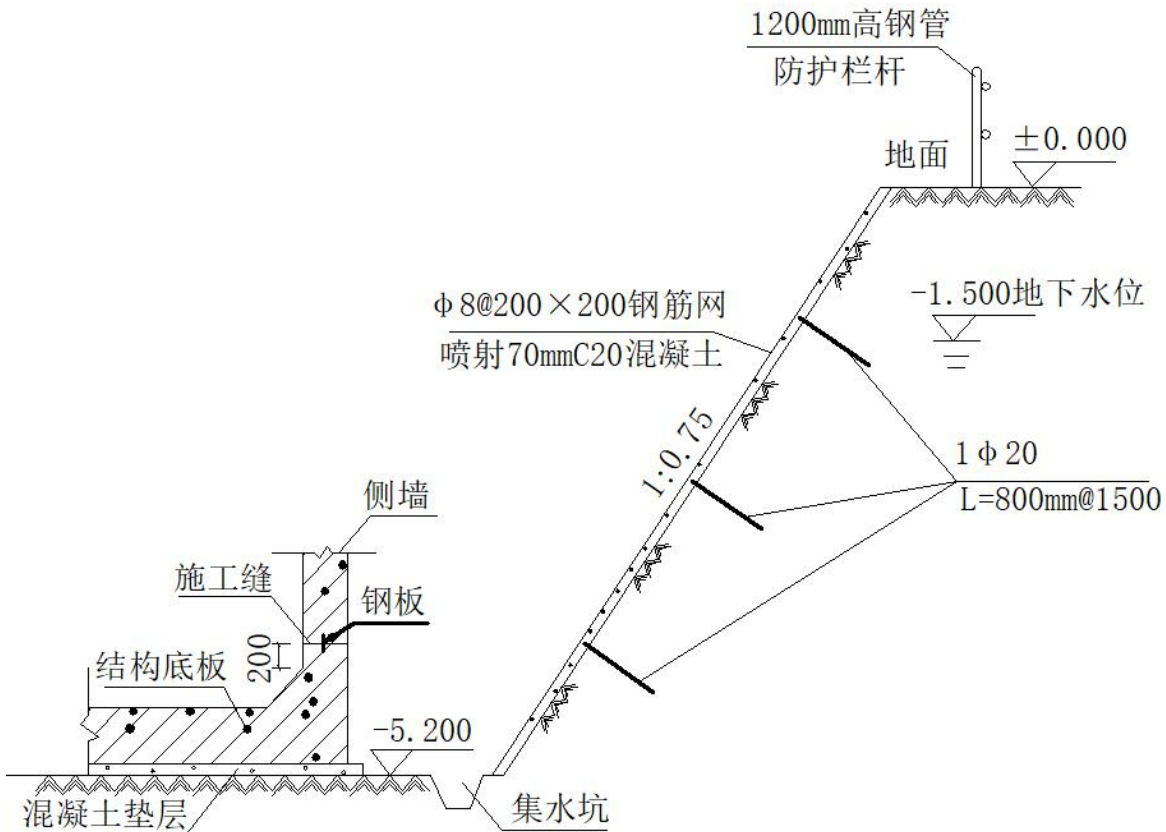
基坑断面示意图（高程单位：m，尺寸单位：mm）
